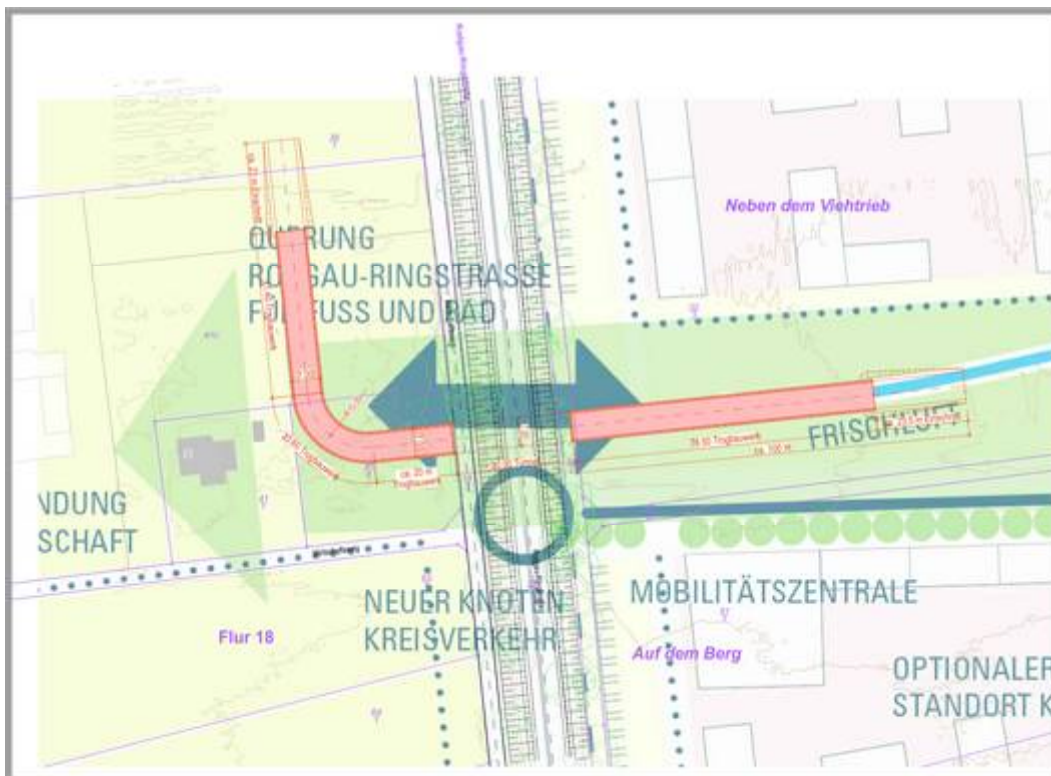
Planungsvariante 2 (Querung als Unterführung) – Lageplan.
